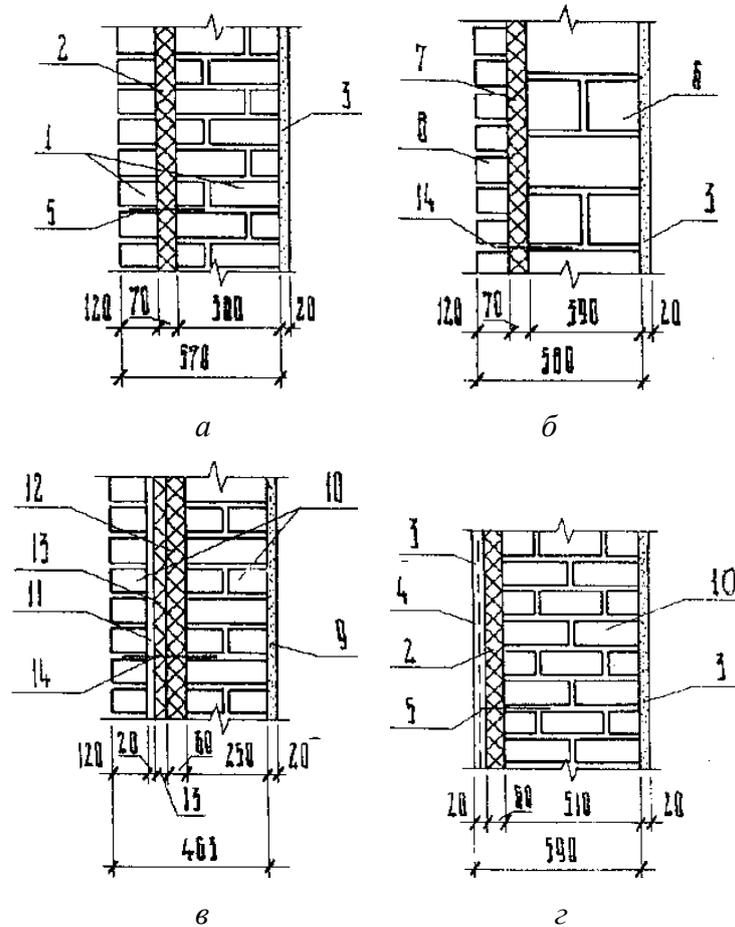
Кирпичные стены с утеплителем из теплоизоляционных плит и панелей: *а* — колодцевая кладка; *б* — с несущим слоем из блоков; *в* — с замкнутой воздушной прослойкой; *г* — с декоративной штукатуркой: 1 — кирпич силикатный на цементно-песчаном растворе; 2 — теплоизоляционные плиты ISOVER марки OL-E или OL-A ДСТУ 8.2.7.38—96; 3 — штукатурка цементно-песчаная, толщина 20 мм; 4 — стеклосетка; 5 — металлические связи из оцинкованной стали Ø4 Вр1 через 0,5 м в длину стены и через 5 рядов по высоте; 6 — мелкие бетонные блоки; 7 — теплоизоляционные плиты ISOVER марки KL или KL-A толщиной 70 мм; 8 — кирпич керамический пустотелый плотностью 1400 кг/м³ на цементно-песчаном растворе марки М25; 9 — штукатурка известково-песчаная; 10 — кирпич обычный глиняный на цементно-песчаном растворе марки М25; 11 — воздушная прослойка толщиной 20 мм; 12 — теплоизоляционные плиты ISOVER марки KL или KL-A толщиной 60 мм ДСТУ 8.2.7.56—96; 13 — теплоизоляционные плиты с ветрозащитной облицовкой ISOVER марки RKL-EJ толщиной 13 мм ДСТУ 8.2.7.56—96; 14 — металлические связи из оцинкованной стали Ø6 А1 через 1000 мм по длине и через 600 мм по высоте
